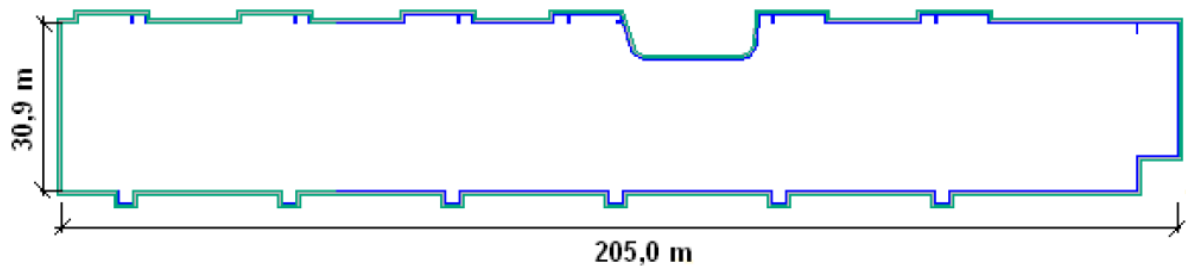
Dimensões da escavação a realizar (Sousa, 2009).
